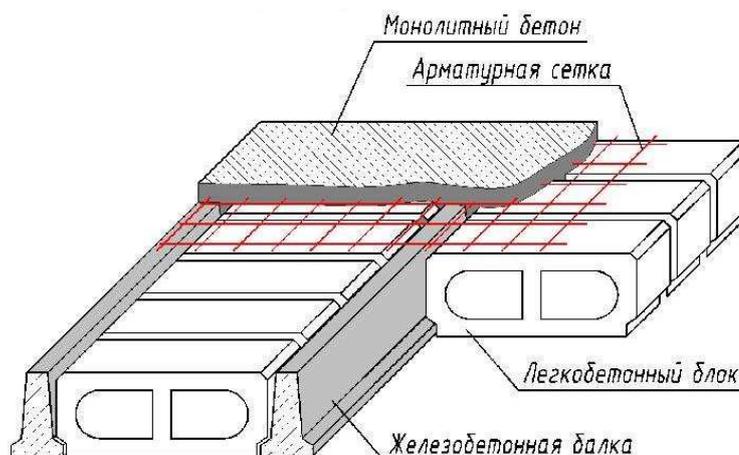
Конструкция сборно-монолитного перекрытия с железобетонными балками из мелкокоразмерных элементов.
